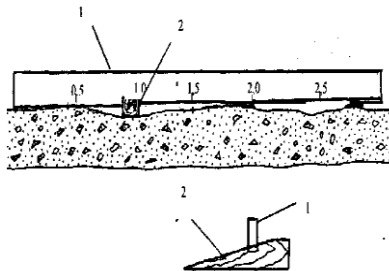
Трехметровая рейка с мерным клинком для измерения ровности дорожного покрытия: 1 – рейка; 2 – мерный клин
